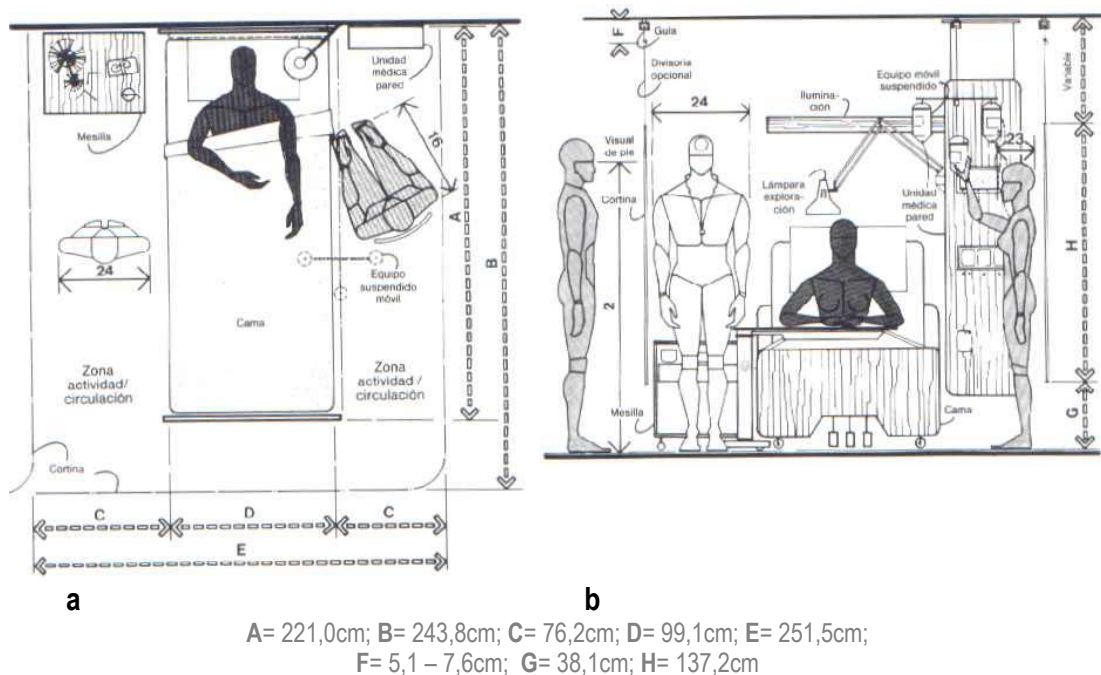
Planta baixa (a) e vista (b) do espaço pessoal do paciente em uma enfermaria
